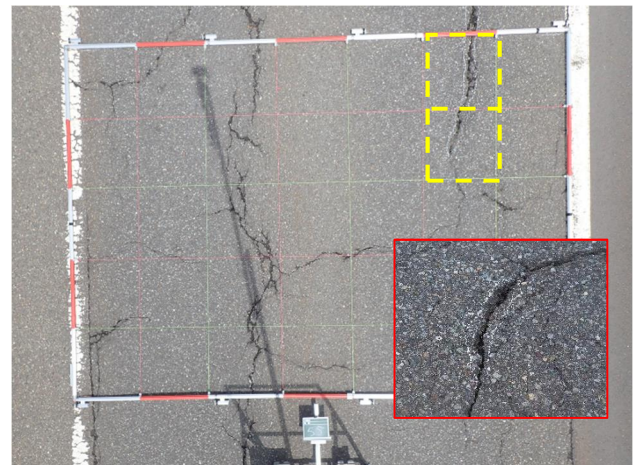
ひび割れ幅の開きが大きいひび割れ部欠損マスの例
